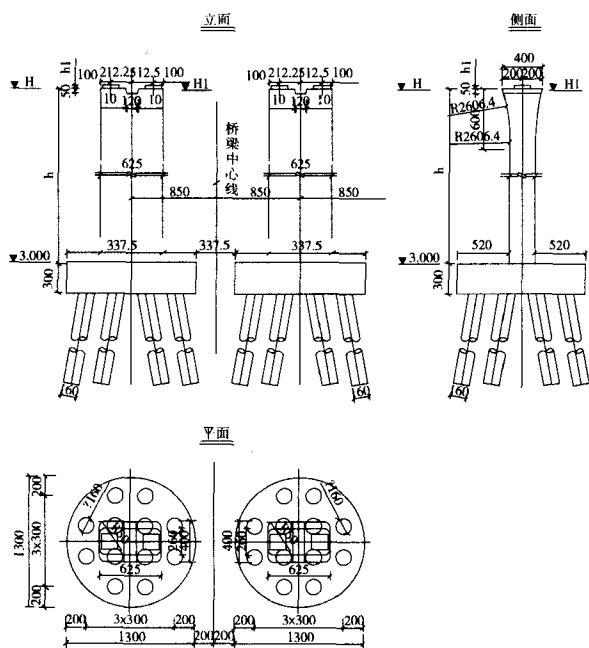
70m跨打入桩基础构造 (尺寸单位: cm)
